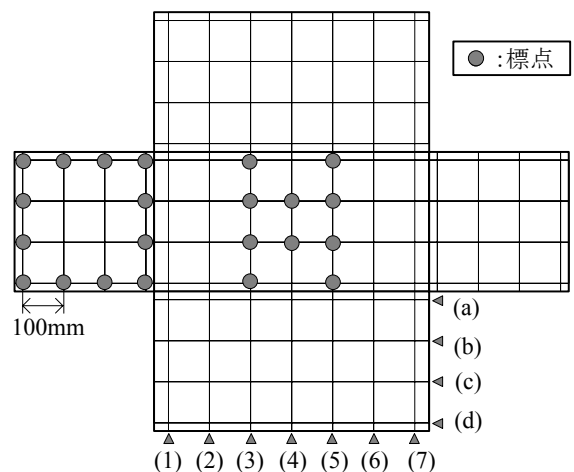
ひび割れ測定方法およびゲージ貼り付け位置
